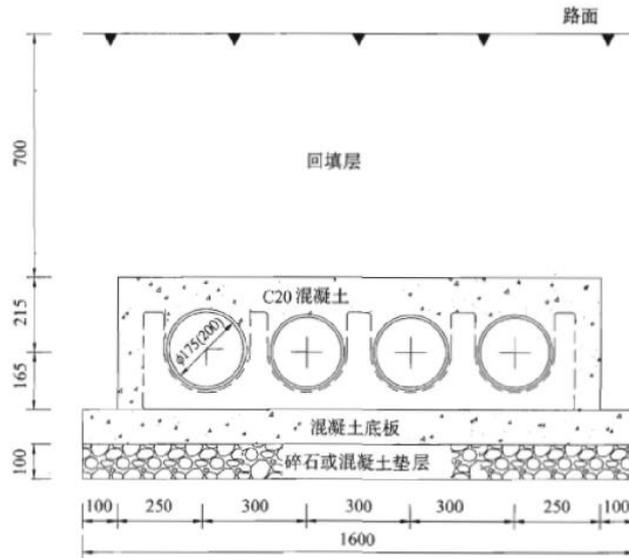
排管电缆沟敷设断面图 (单位: mm)
